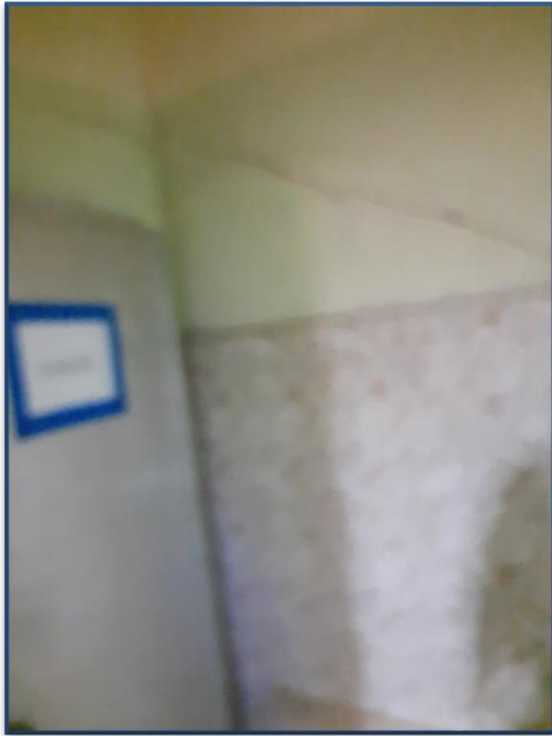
Fissures inclinés à 45° sur les murs (intérieures et extérieures) [44]
